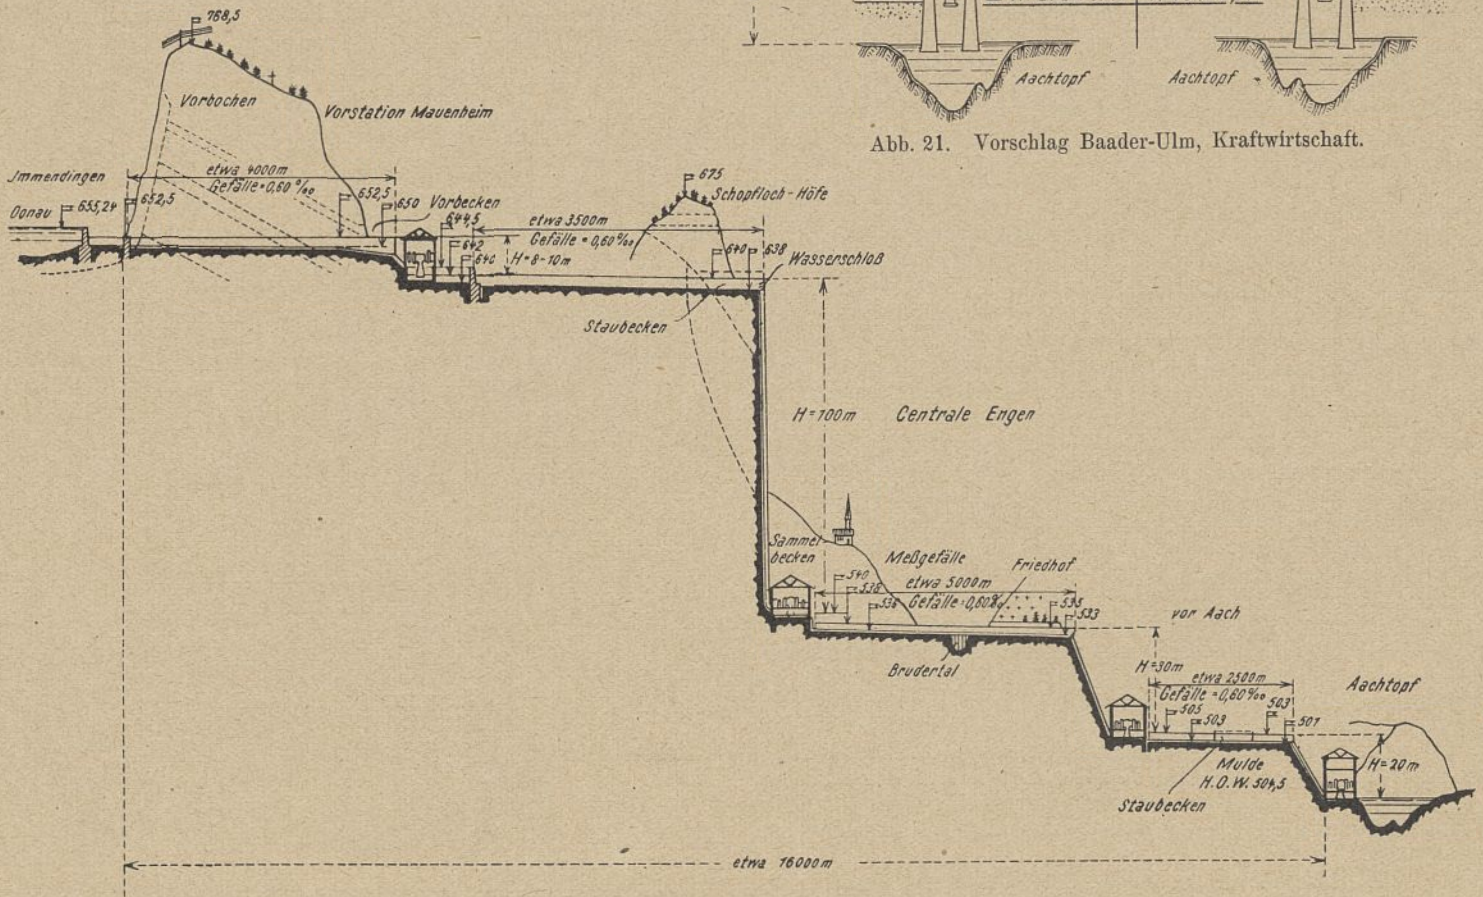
Vorschlag Baader-Ulm, Höhenplan.
